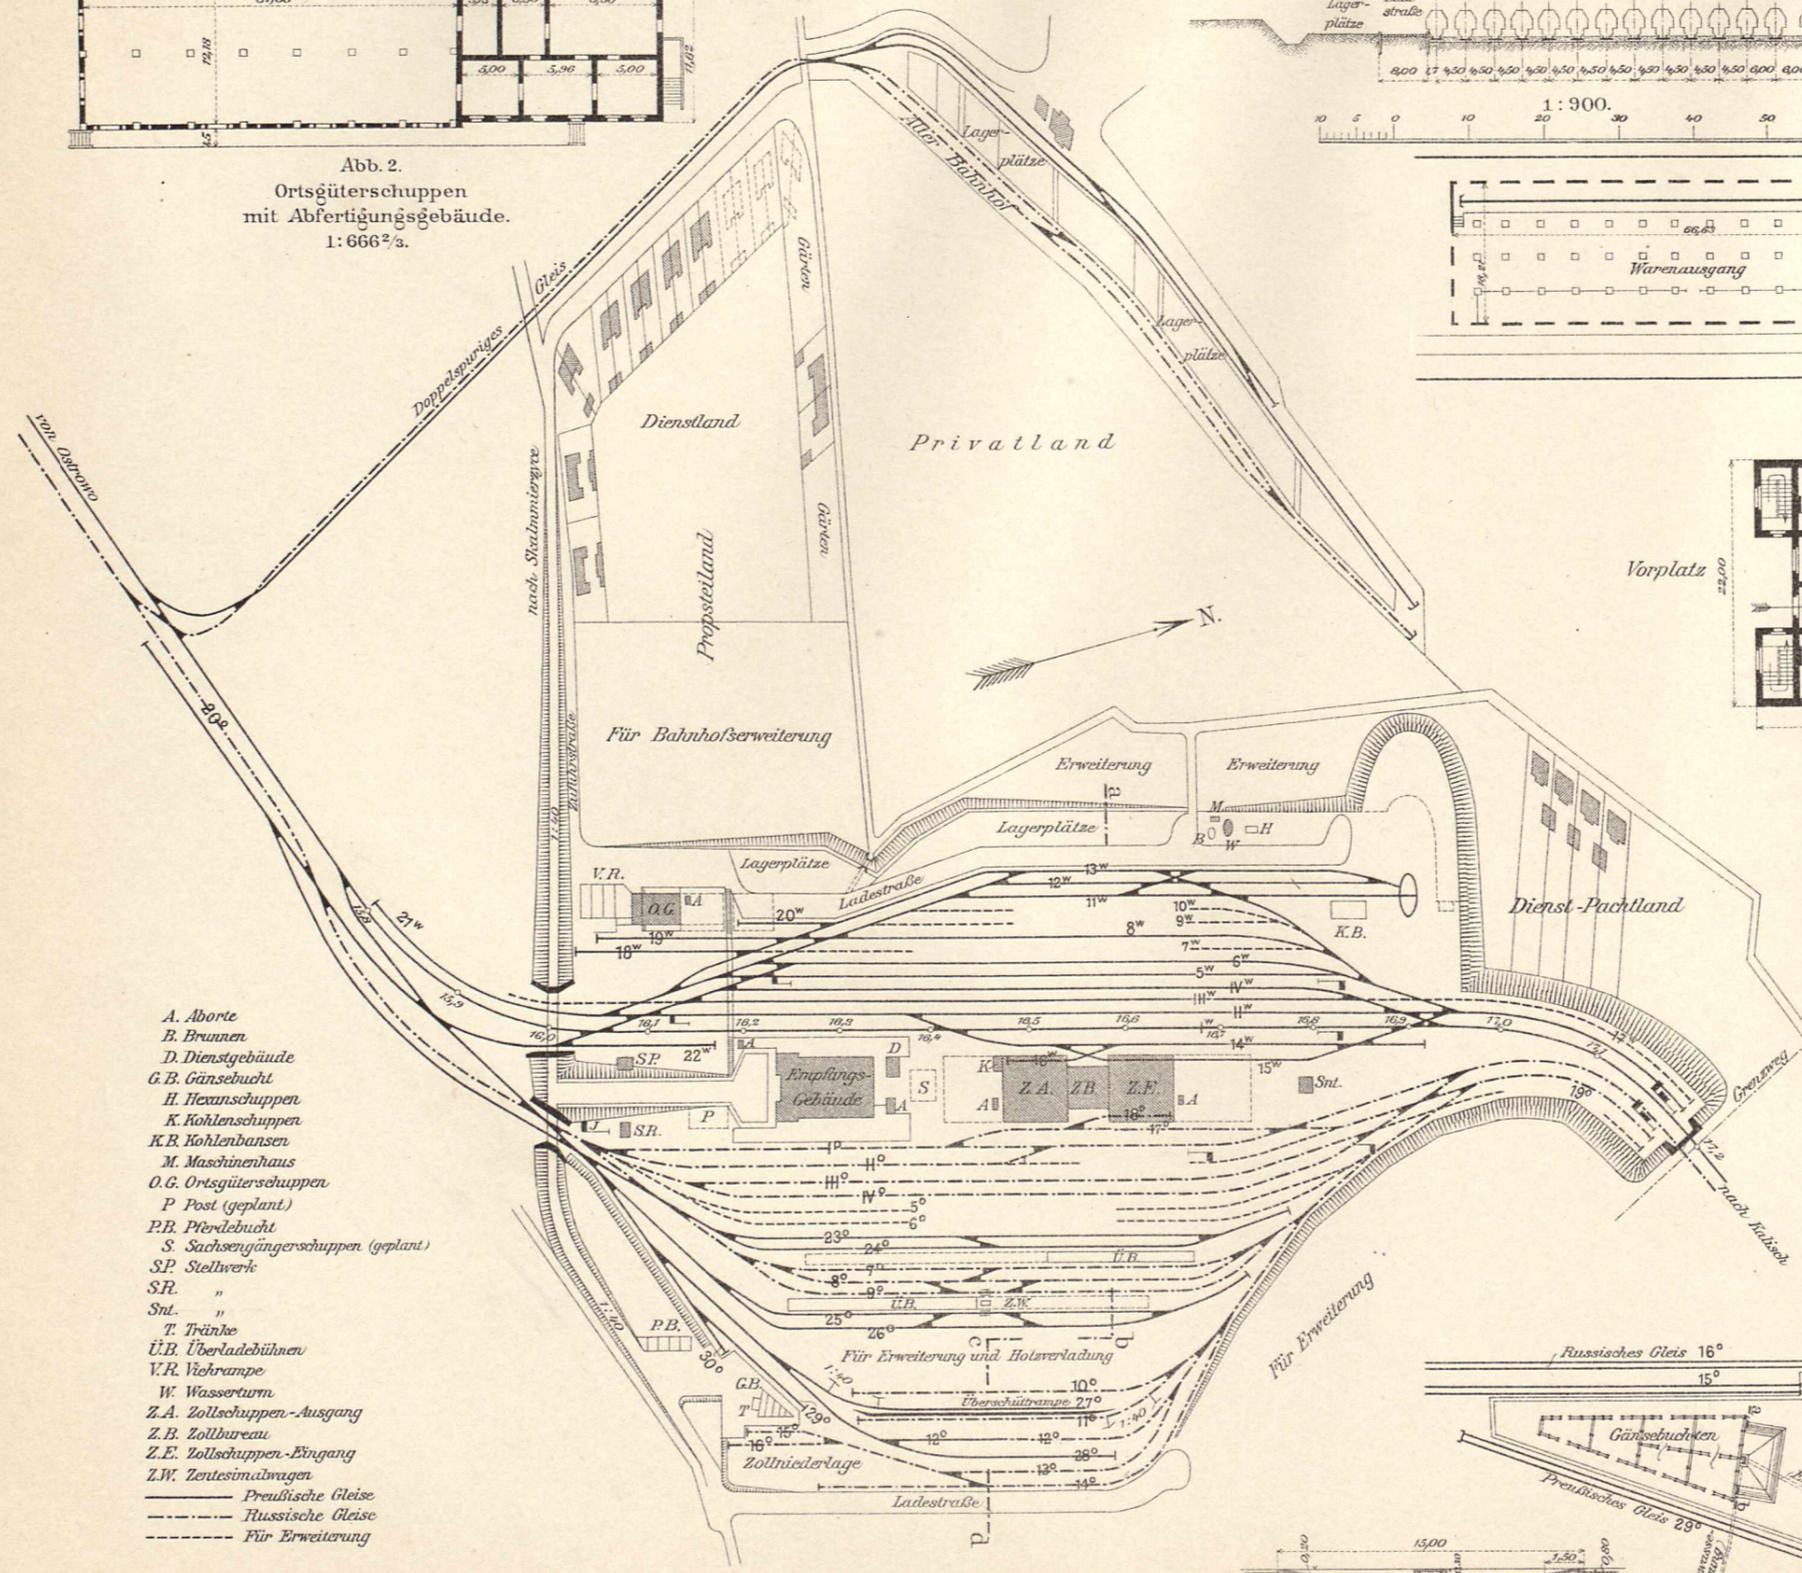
Bahnhof Skalmierzyce. Lageplan.
